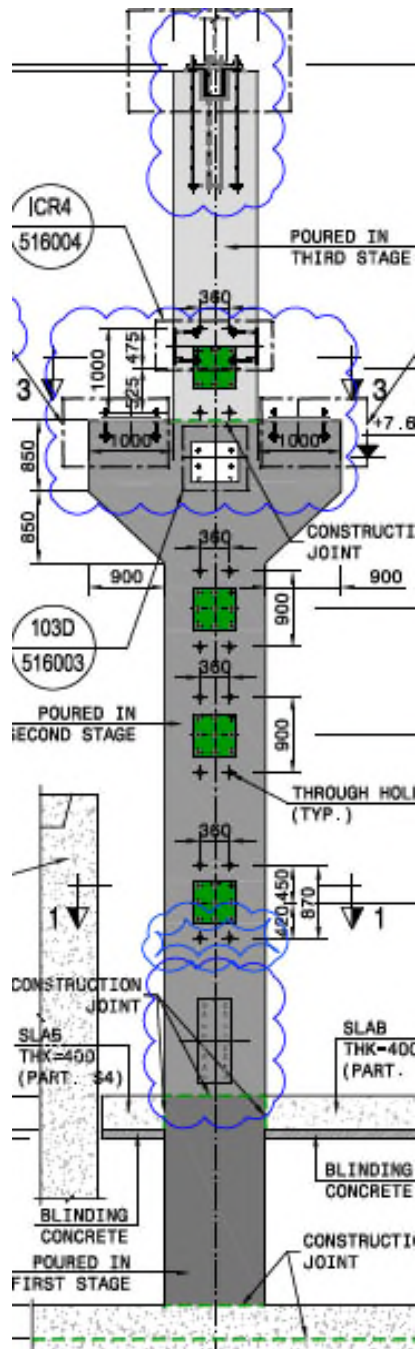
Placas embebidas solicitadas por el cliente para futuras conexiones.
